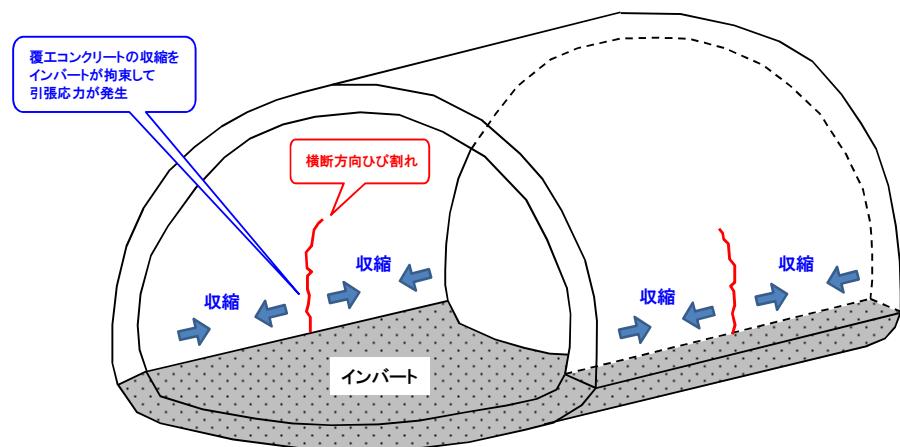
インバート拘束によるひび割れ発生の概念
